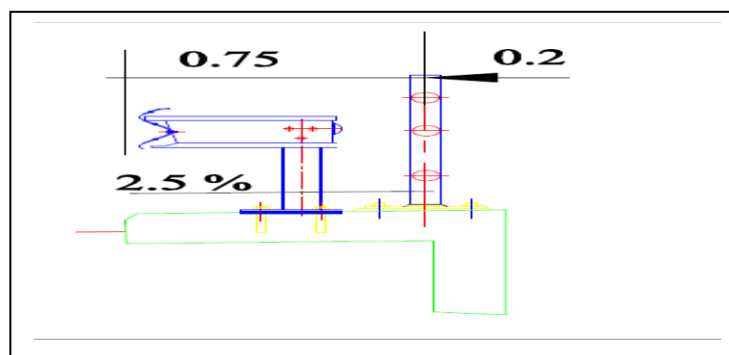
Coupe transversale du trottoir-corniche avec éléments non porteurs.
